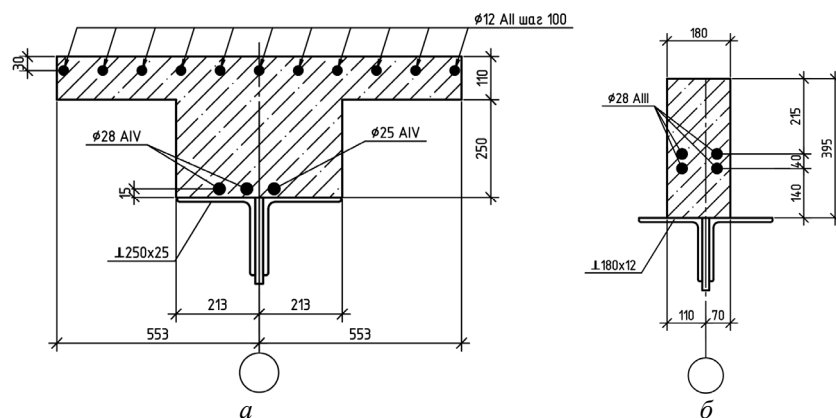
Расчетное сечение верхнего пояса фермы: *a* — верхний пояс главной фермы; *б* — верхний пояс второстепенной фермы
